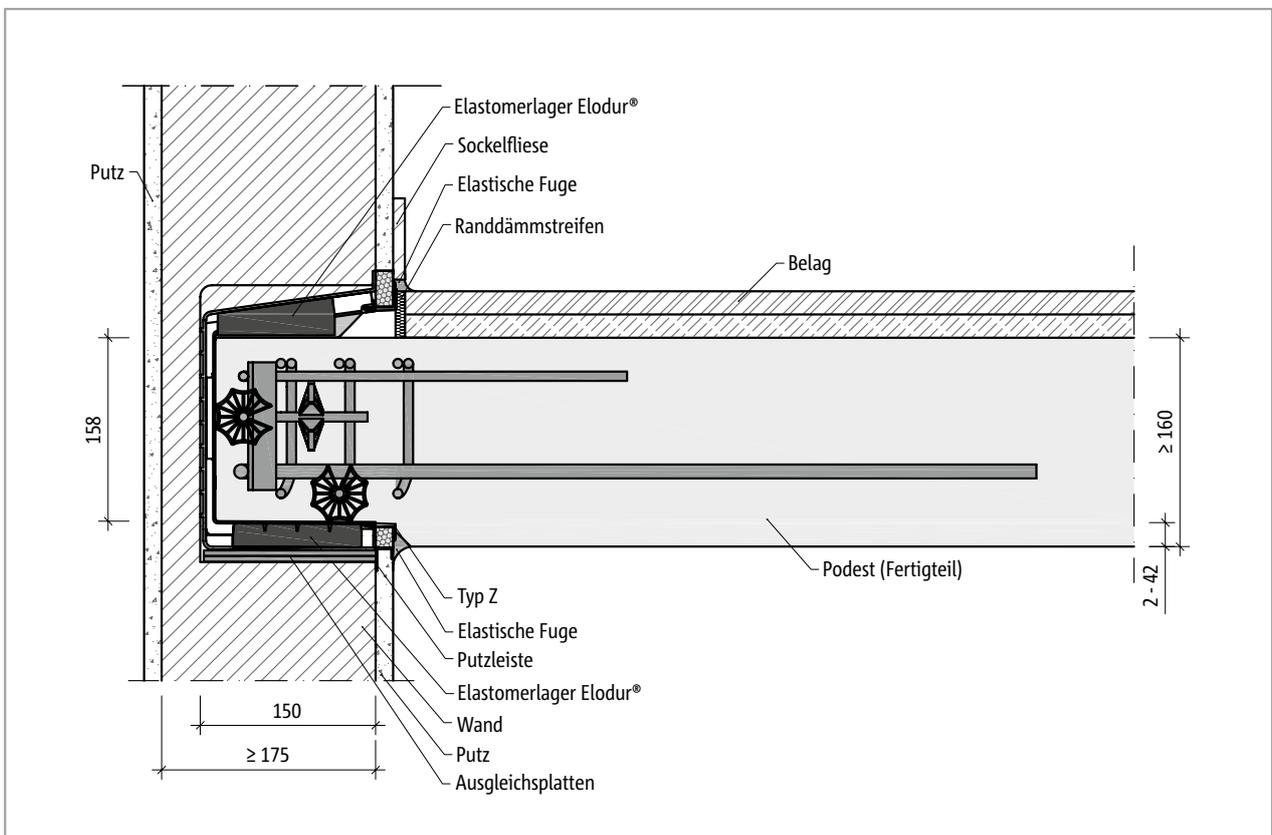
Schöck Tronsole® Typ Z-V+V-T: Einbauschnitt Fertigteilpodest
